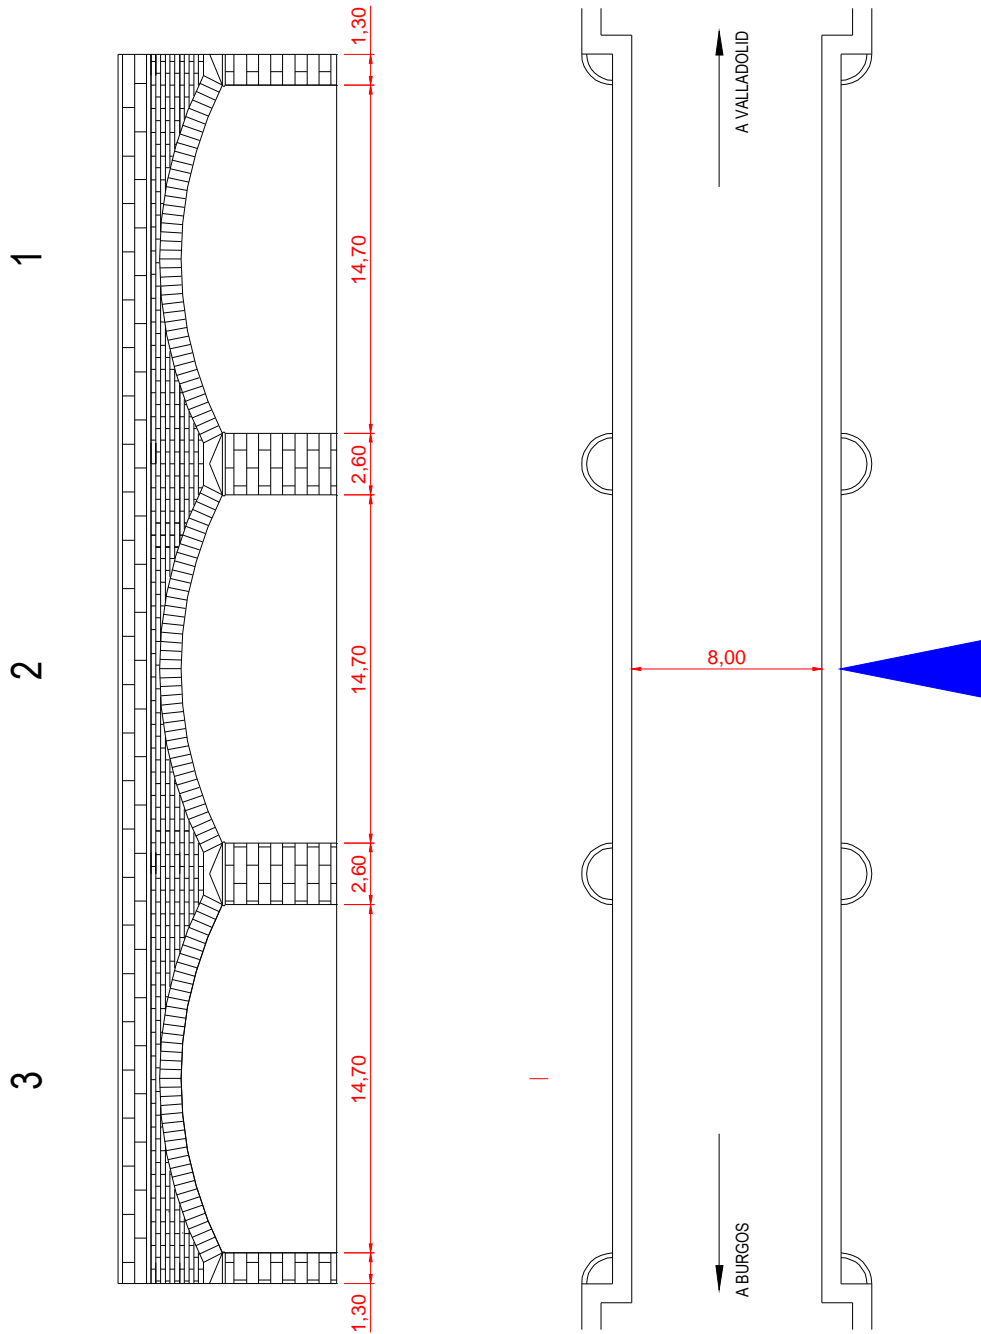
Planta y alzado de aguas arriba del puente de San Isidro en Dueñas
